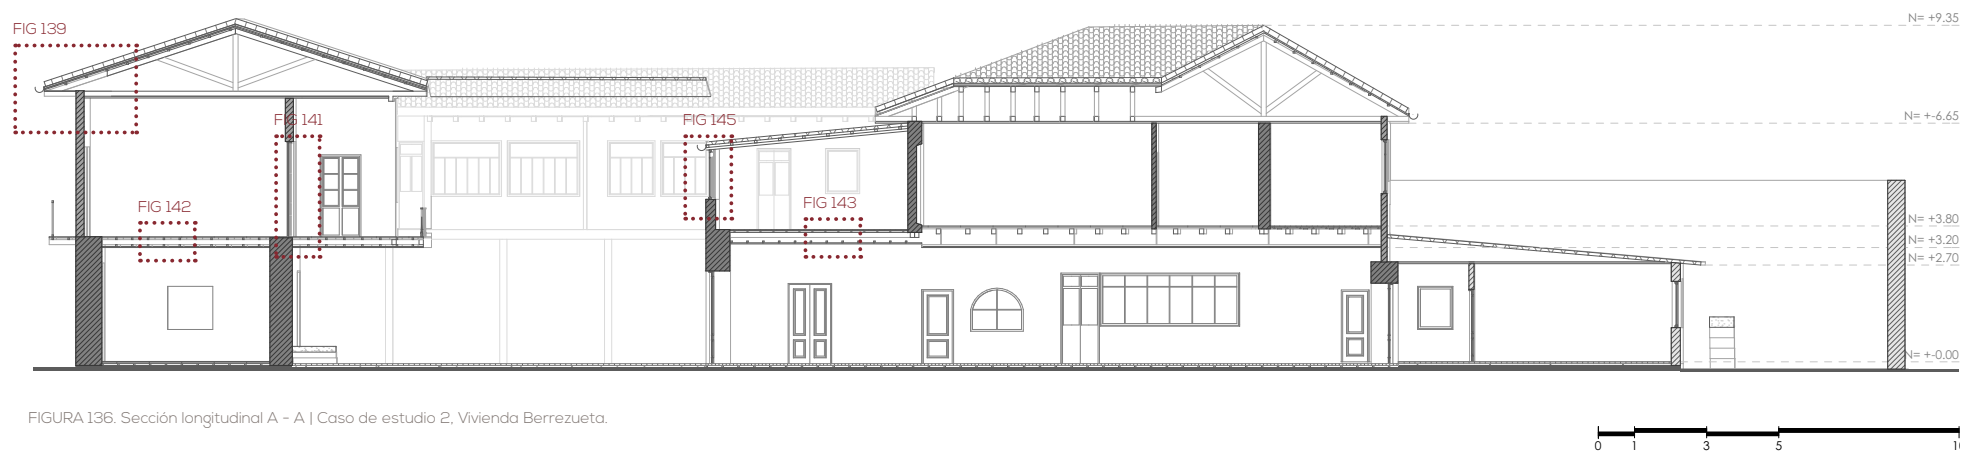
Sección longitudinal A - A | Caso de estudio 2, Vivienda Berrezueta.
